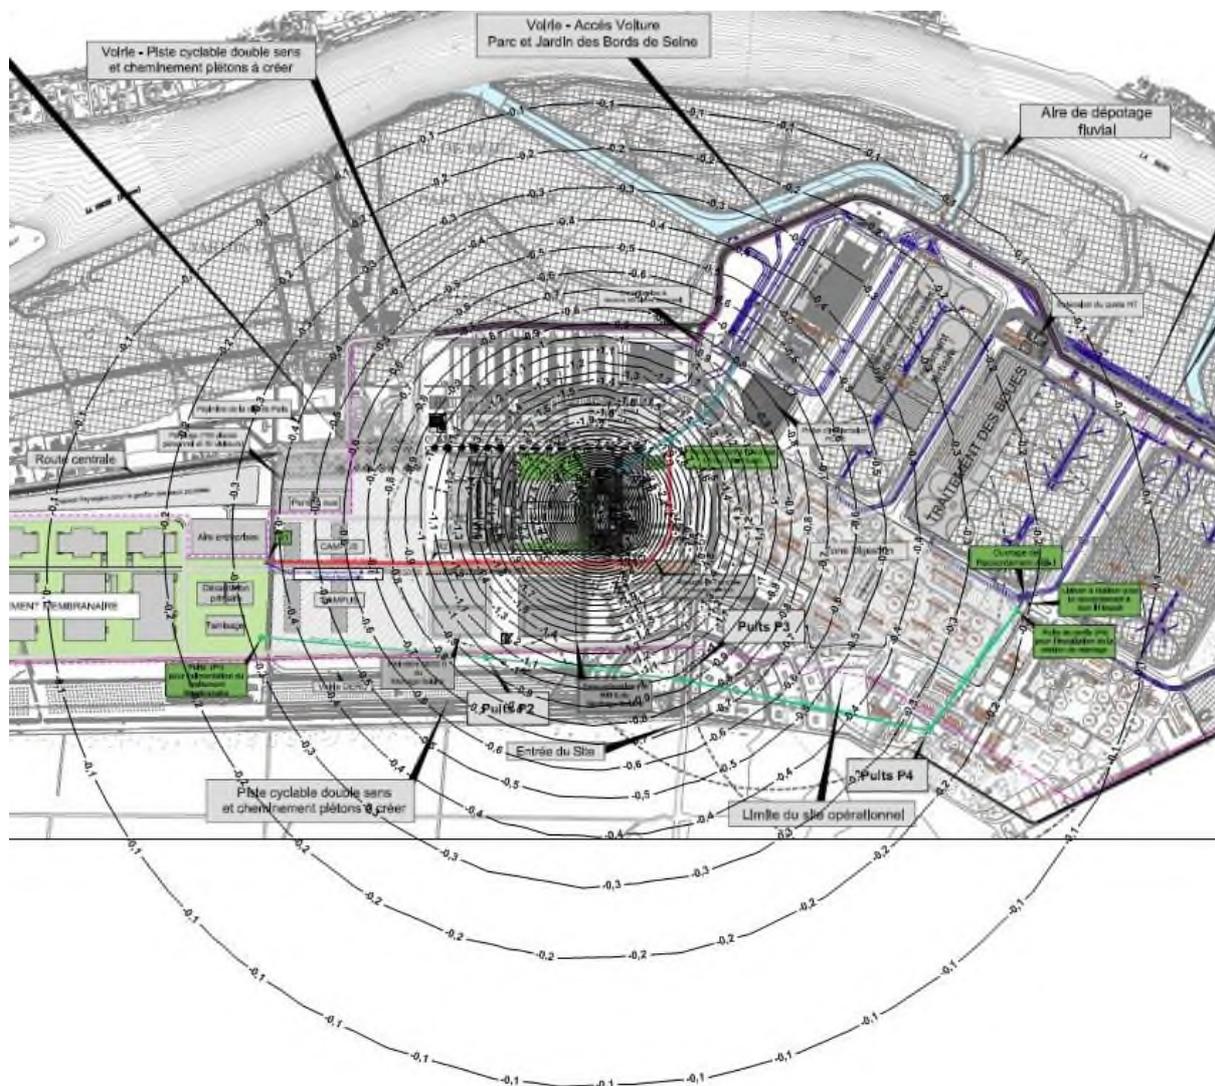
Modélisation du rabattement de nappe projeté sur le plan aérien du futur ouvrage.
